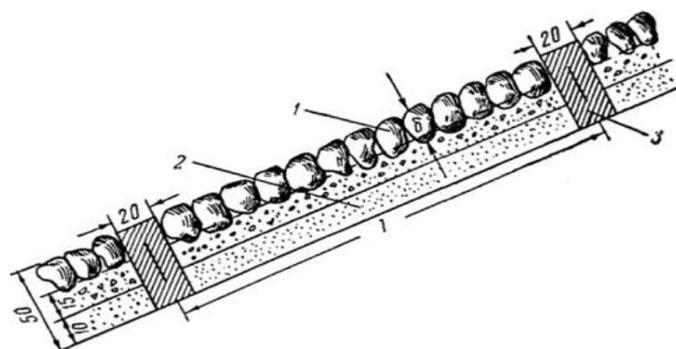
Одиночная мостовая в бетонных клетках: 1 - камень; 2 - подготовка; 3 - армированные бетонные балки
